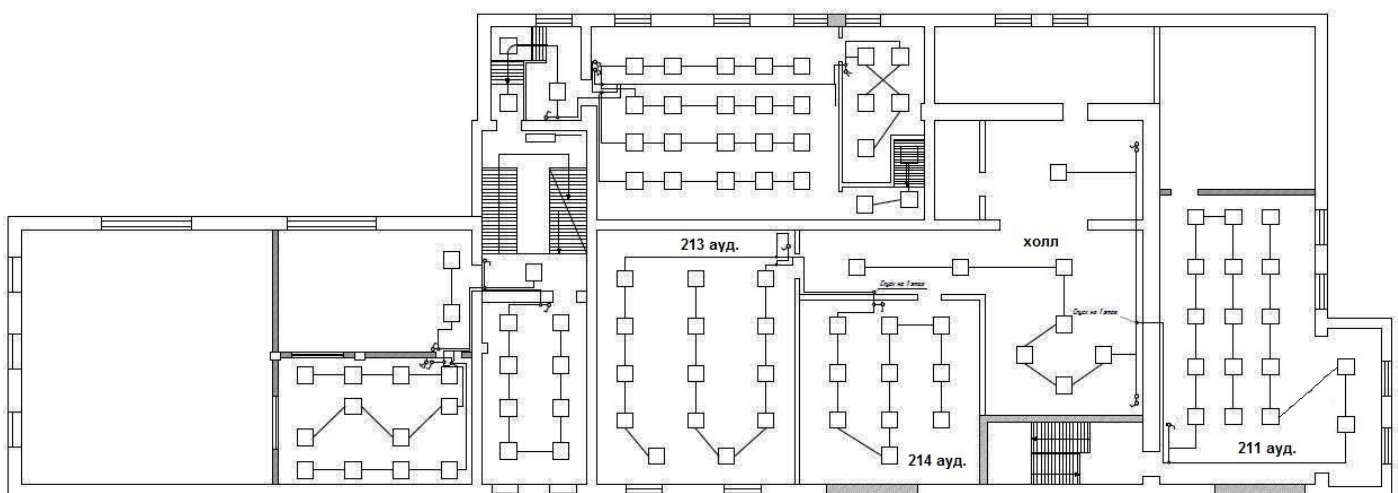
Исполнительный план освещения 2 этажа здания УНЦ ЭИ (после модернизации)
